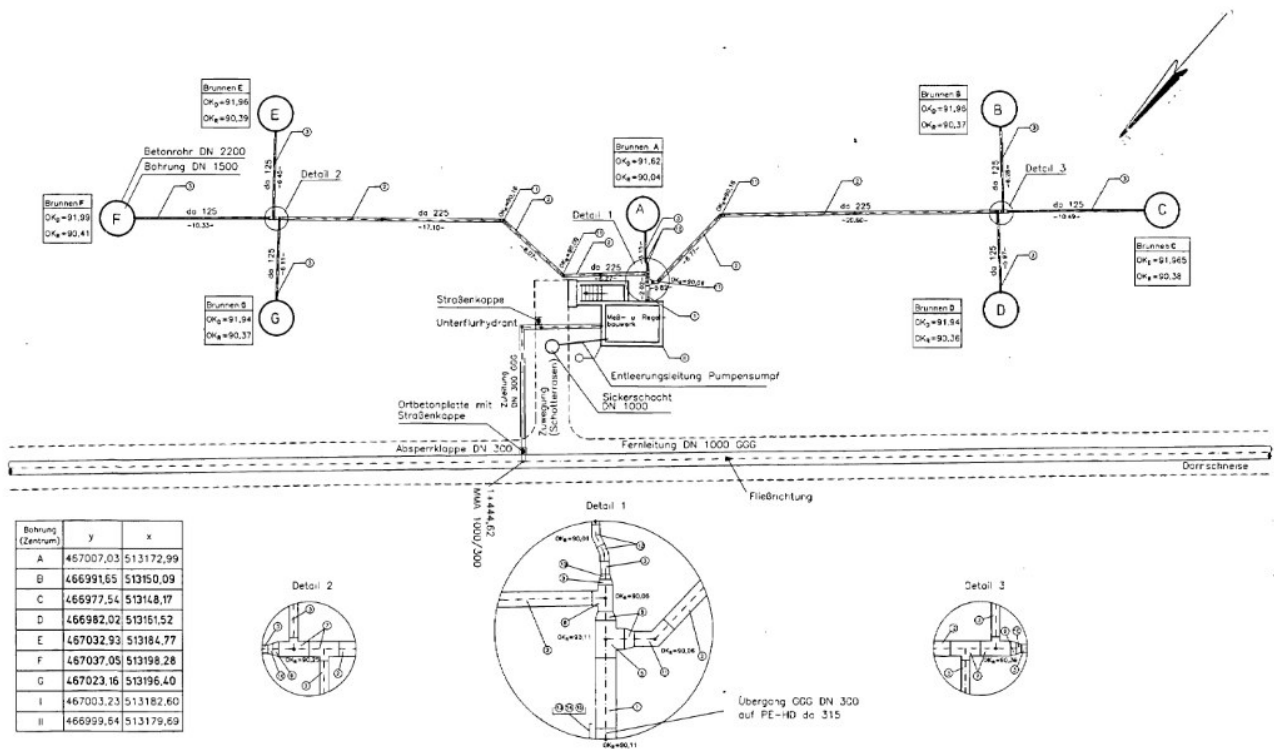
Lageplan des Infiltrationsorgans 1 im Gernsheimer Wald
